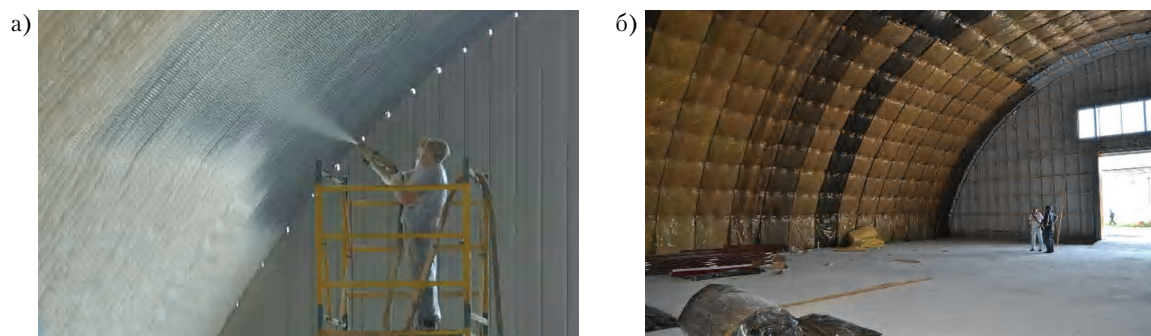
Варианты с внутренним утеплением бескаркасных арок: а) утепление напылением пенополиуретаном; б) устройство внутреннего утепления минераловатными плитами.
